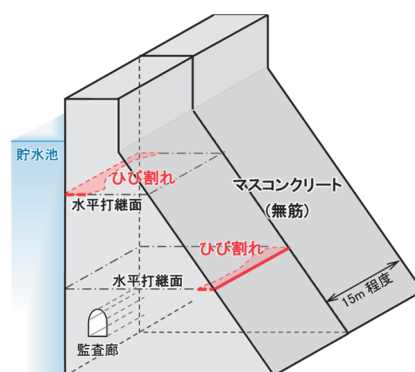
コンクリートダム堤体内部（水平打継面沿い）のひび割れ（概念図）
